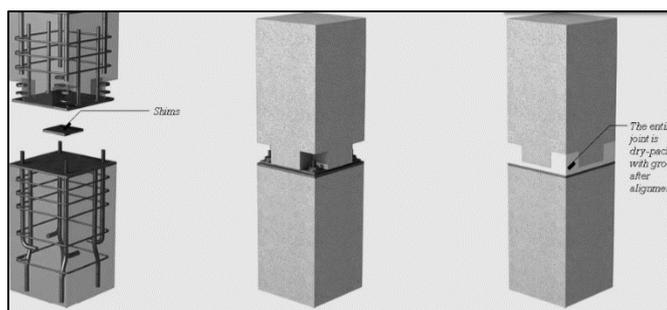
Assemblage poteau-poteau (Source : file:///C:/Users/windows/Desktop/M2/préfa/Dr.KP-Jaya.pdf)
